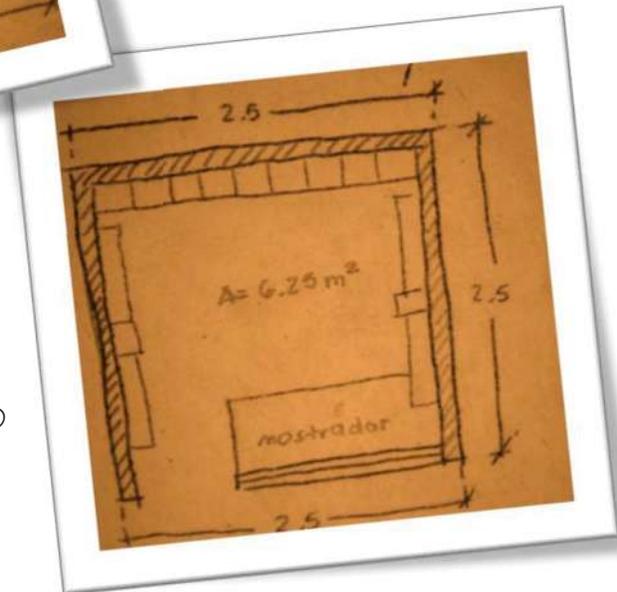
LOCAL DE POLLERÍA Y PESCADERÍA
